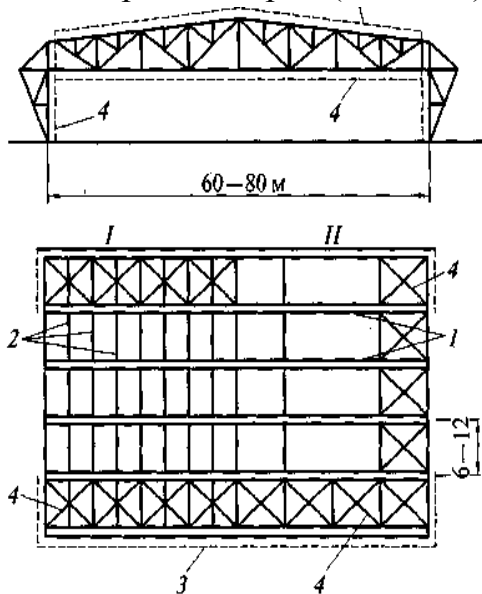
Поперечне компонування каркасу ангара: I, II - план зв'язків відповідно по верхньому й нижньому поясах; 1 — рама; 2 — прогони; 3 — ворота; 4 — зв'язки
